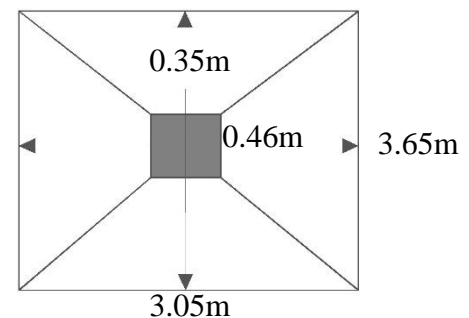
b) Vista en planta de la zapata piramidal truncada rectangular
